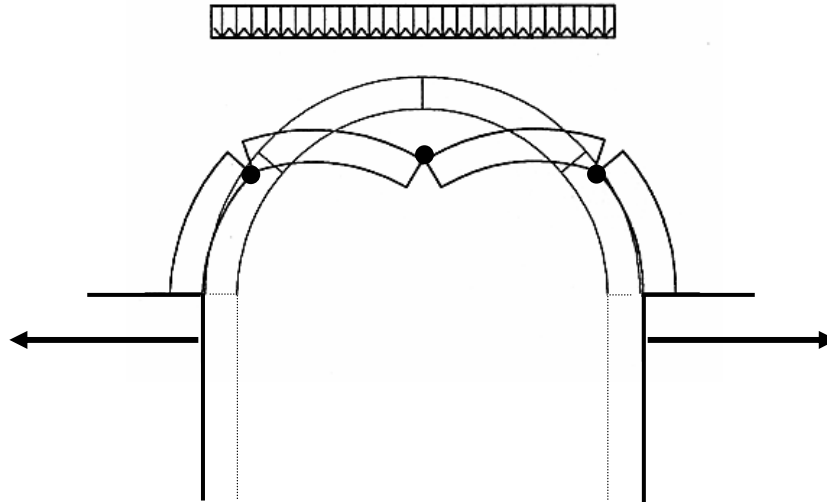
Meccanismo cinematico di collasso con apertura delle imposte: roto-traslazione dei piedritti (o di una parte dei piedritti) più tre cerniere nell'arco (una all'estradosso in chiave, due all'intradosso delle reni).
